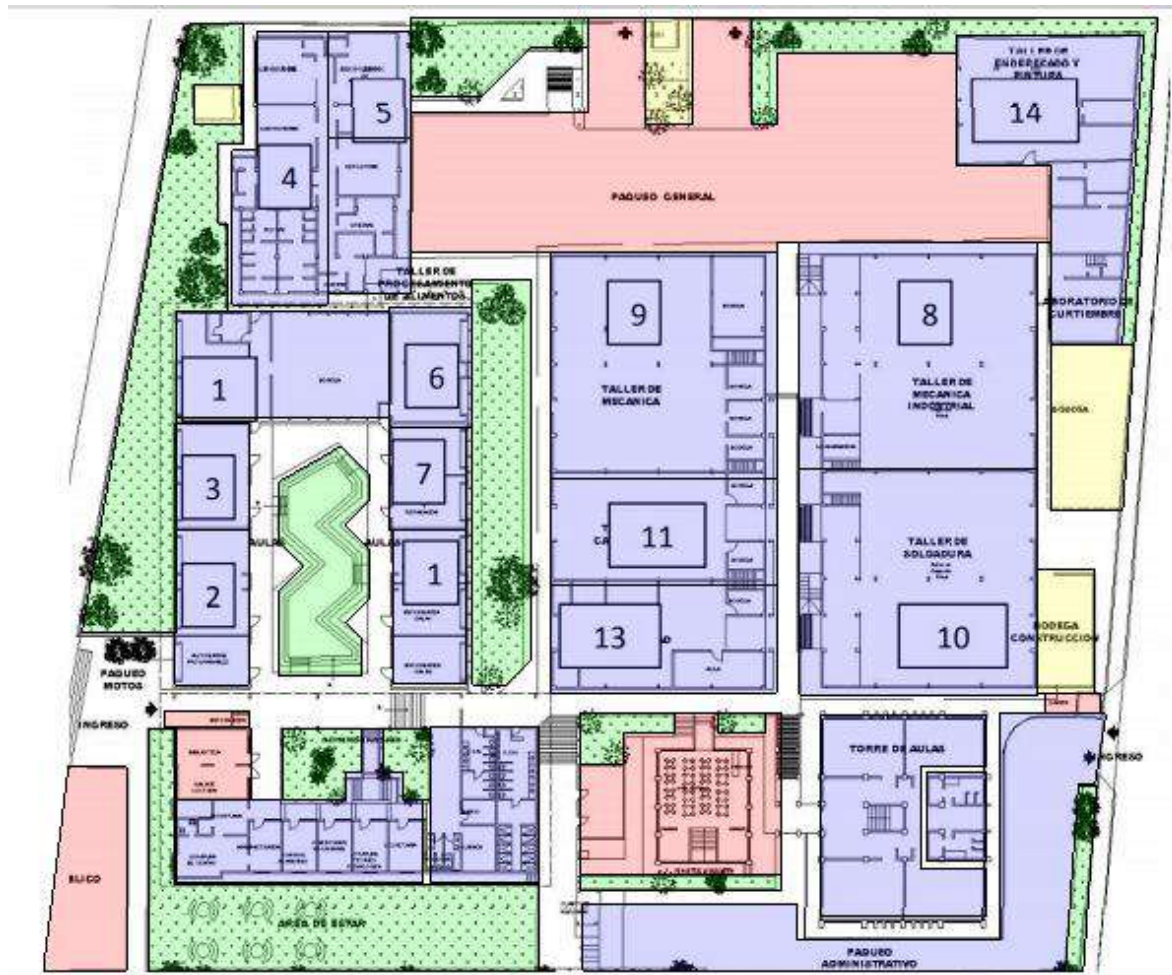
Elaboración Propia basada en Planta arquitectónica de Figura 17.
